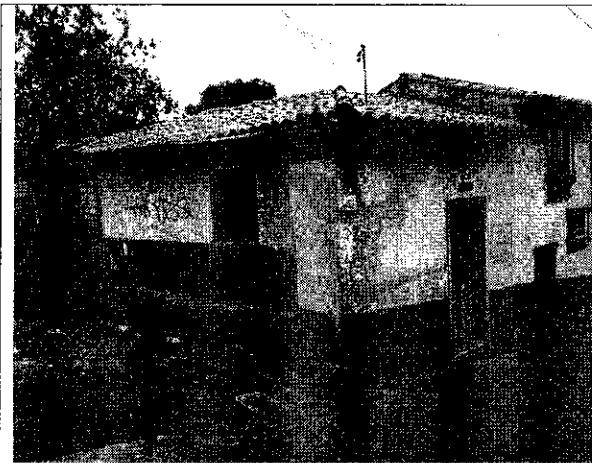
Aspecto general de las fachadas norte y oriente de la edificación emplazada en el predio de la Calle 9 No. 2 – 63 Este.
